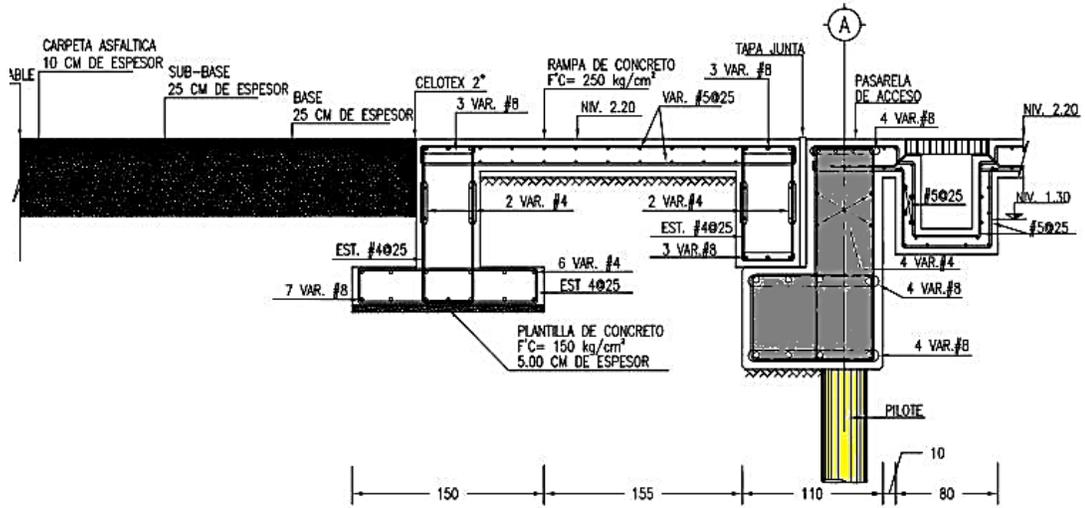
Corte de la cimentación para la Trabe T-10 en eje-A.
